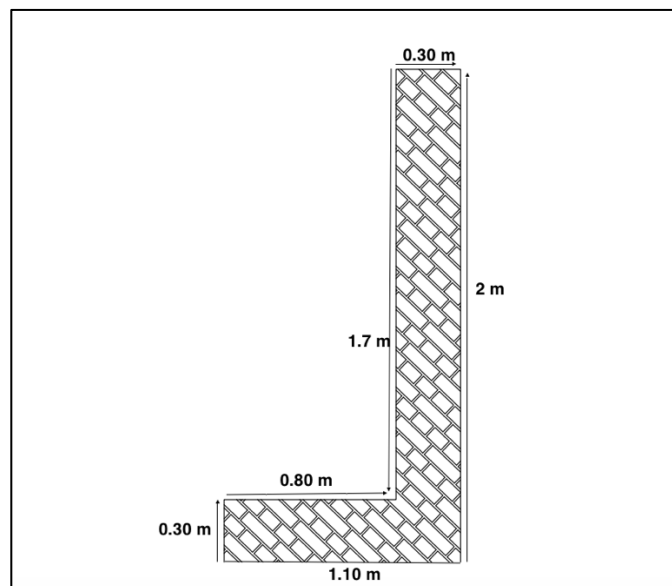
Muro propuesto en el análisis de estabilidad. Fuente: AutoCAD (modificado)
